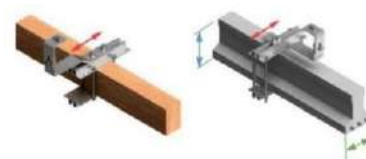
Sistema de abraçamento da viga de madeira e betão.
